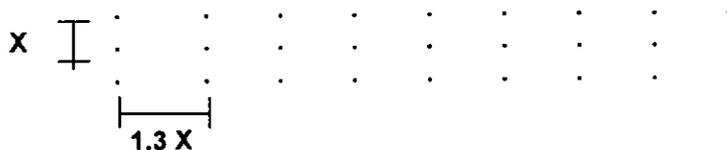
Arreglo de la plantilla rectangular.
